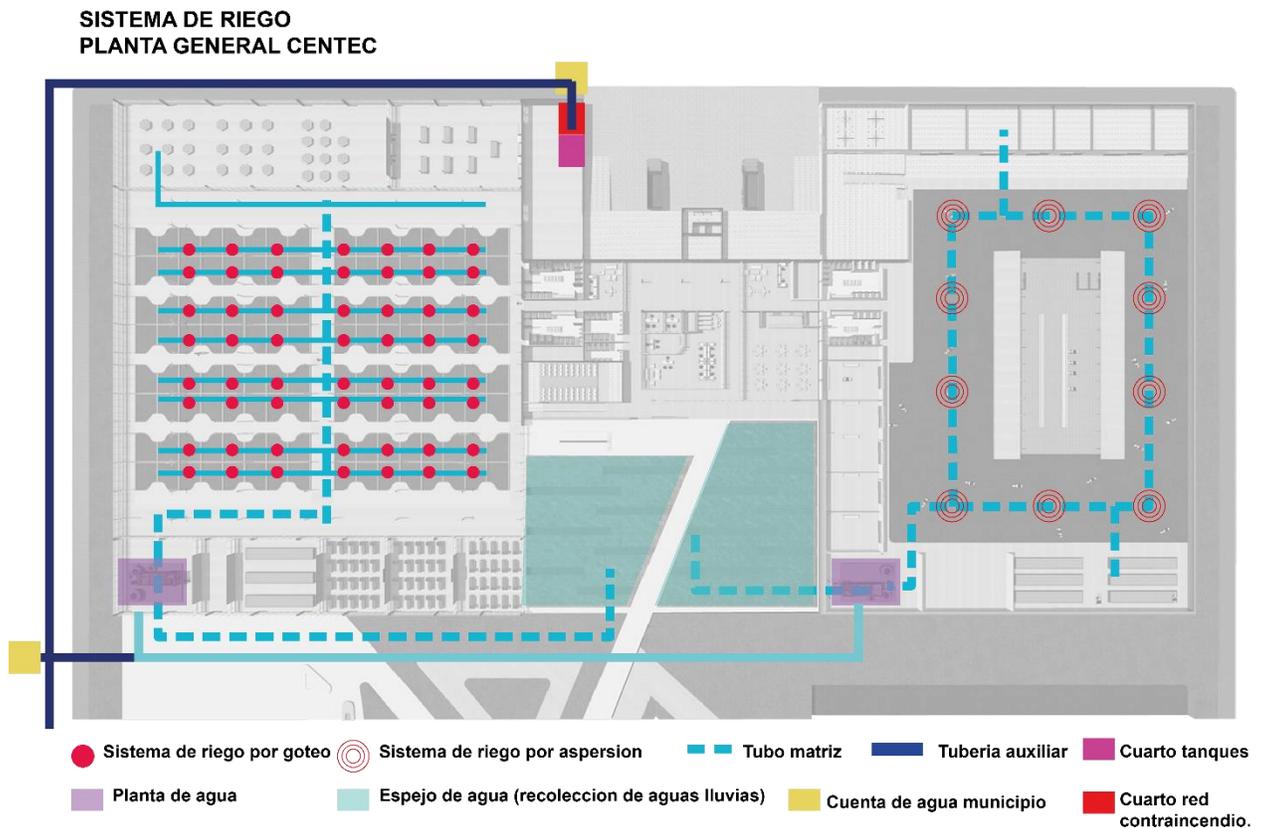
Sistema de riego planta general CENTEC. Elaboración propia
